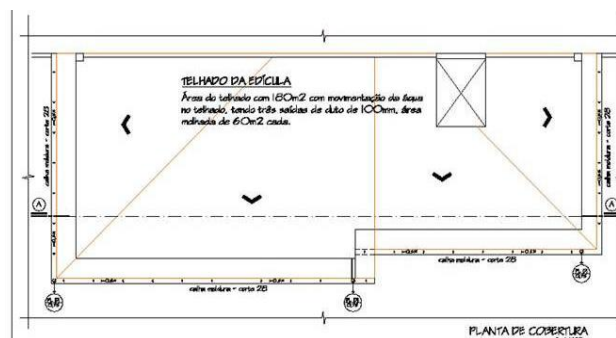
Planta cobertura da Área do Telhado = 178,76m² ≈ 180,00m² . Escala 1/50
